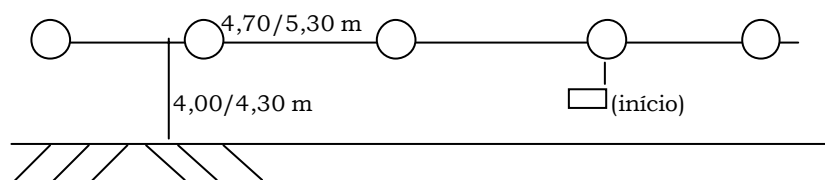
Plano de Fogo Típico
